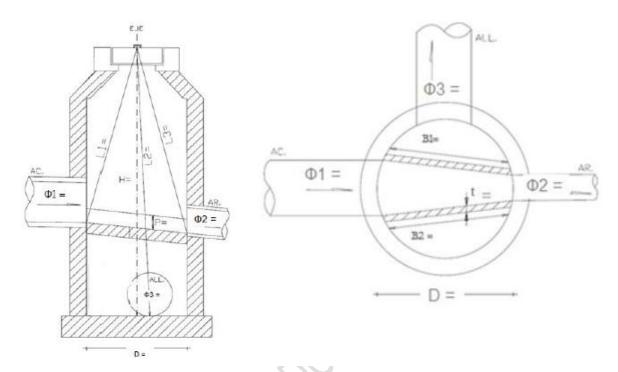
Vista en perfil y planta del aliviadero de cañuela elevada en cámara.
